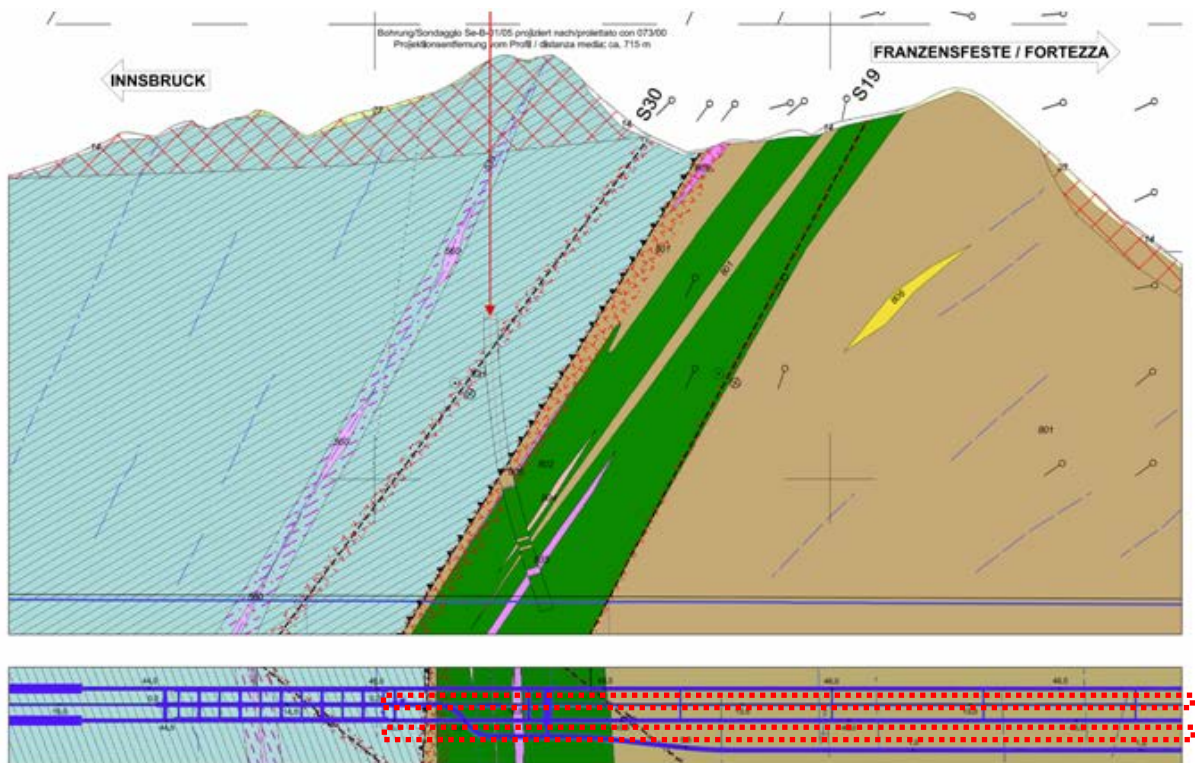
Auszug aus dem geomechanischen Längsprofil und des geologischen Lageplans [2] mit Angabe des
